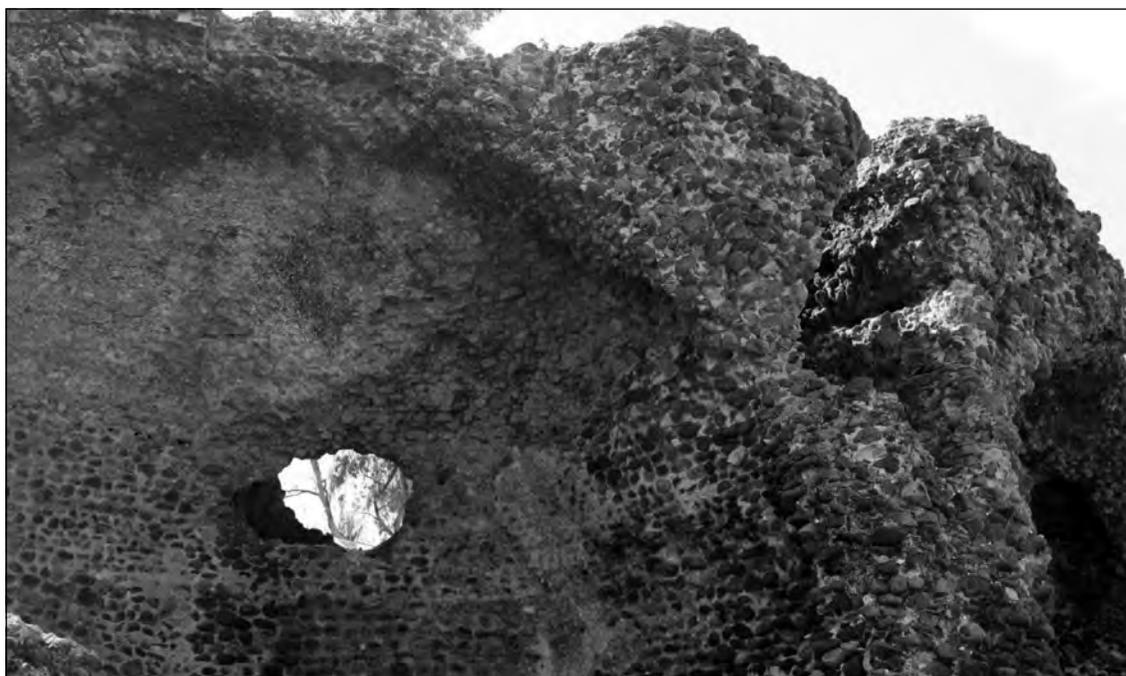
A la izquierda, la abertura en la bóveda de la sala 8; tras ella, se ve parte de la galería superior. Y a la derecha, la finalización o salida al exterior de la galería situada en el muro medianero entre las salas 7 y 8
